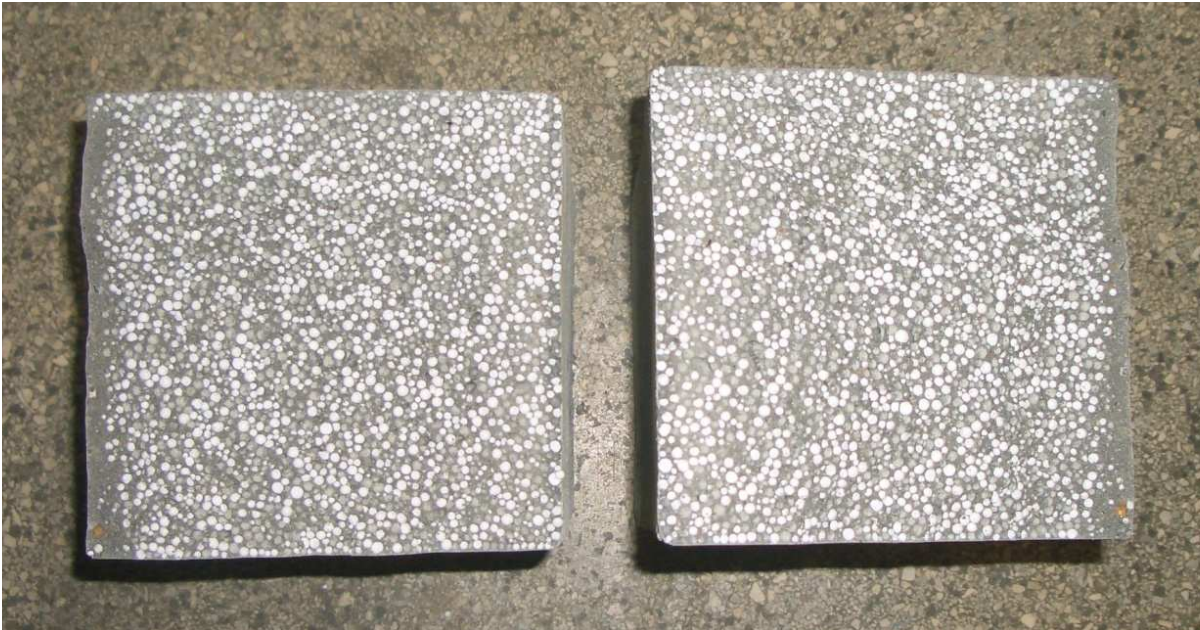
Prisma de Concreto Leve com EPS rompido em ensaio de flexão.
